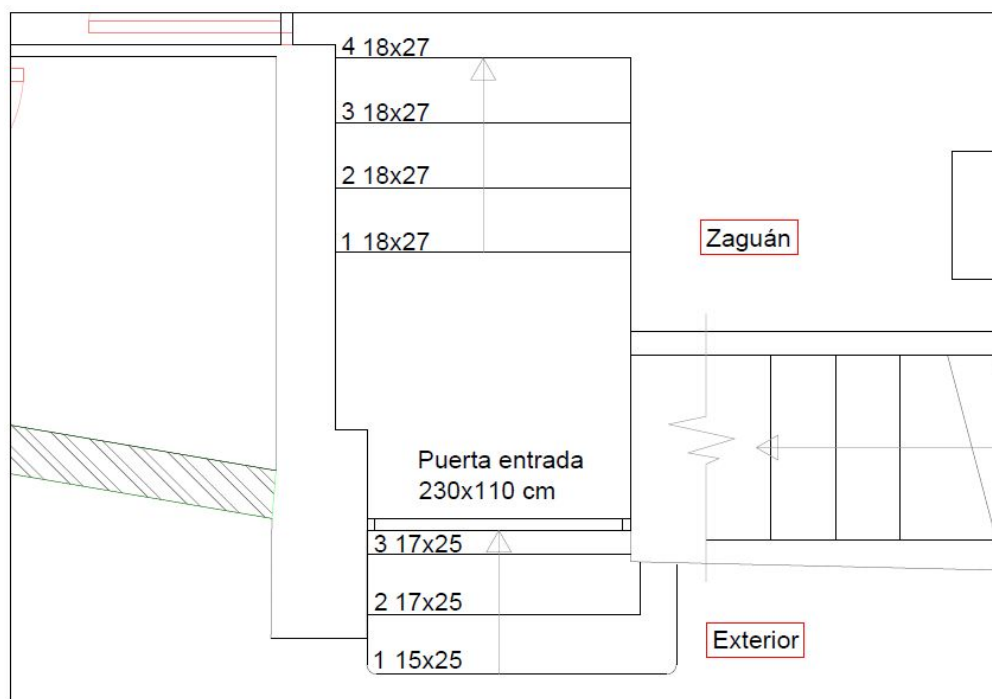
Planta entrada, BH E5 (Fuente: Anejo A)
